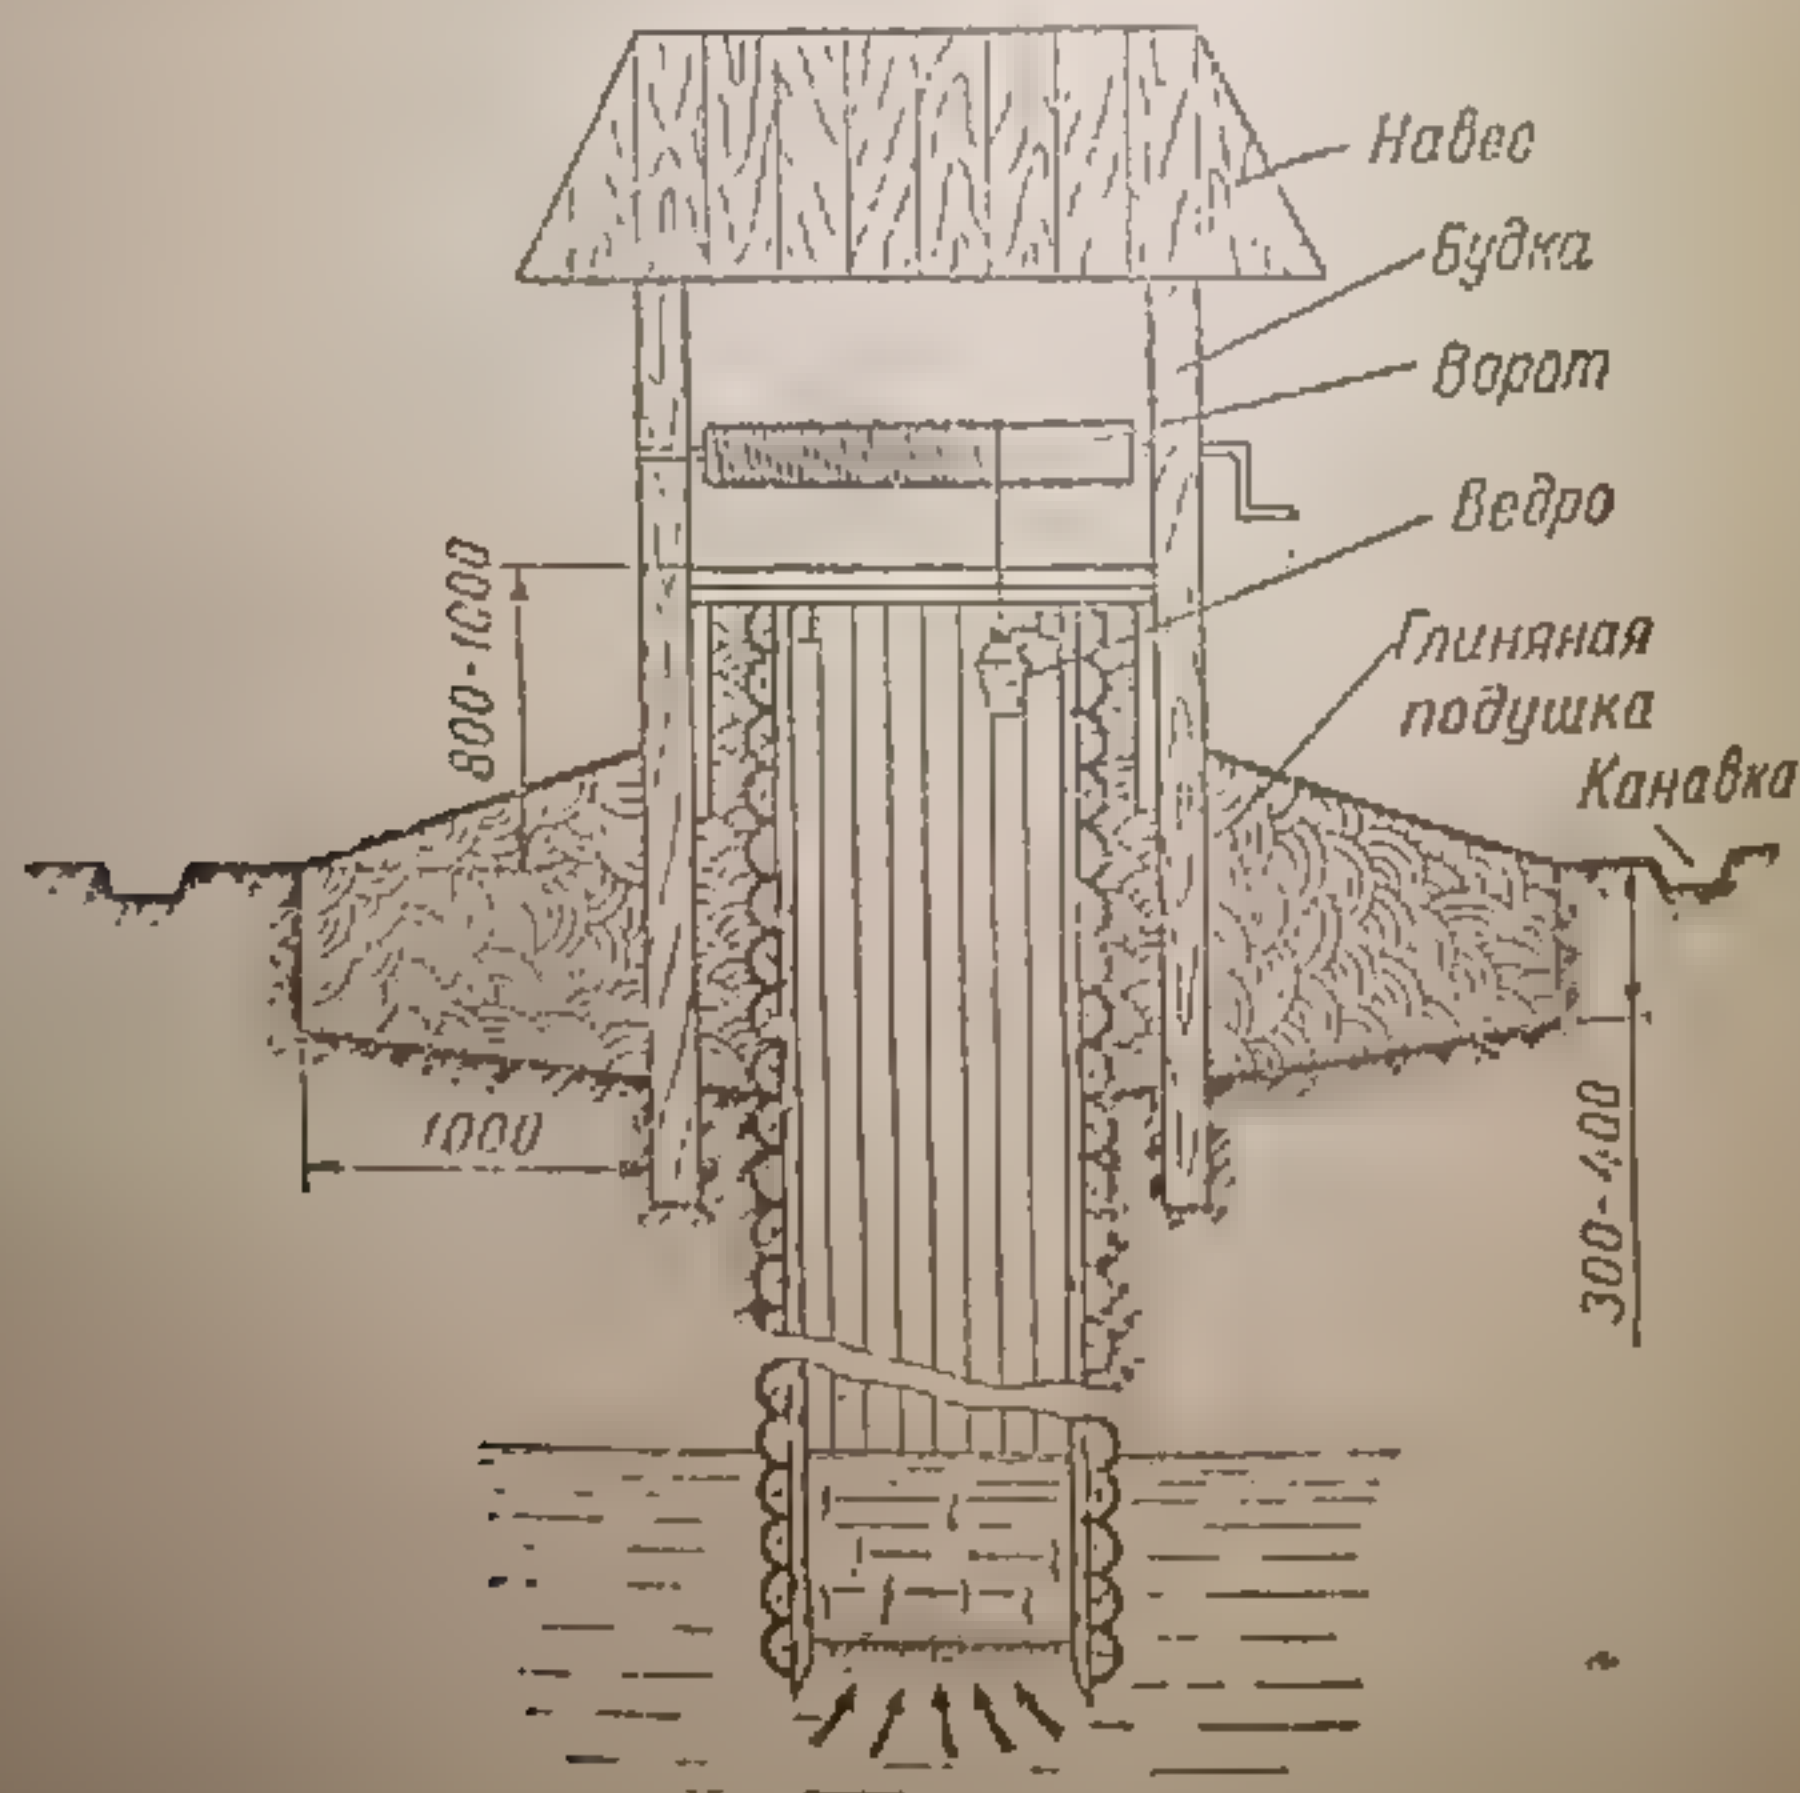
Срубовый шахтный колодец с защитными устройствами.
